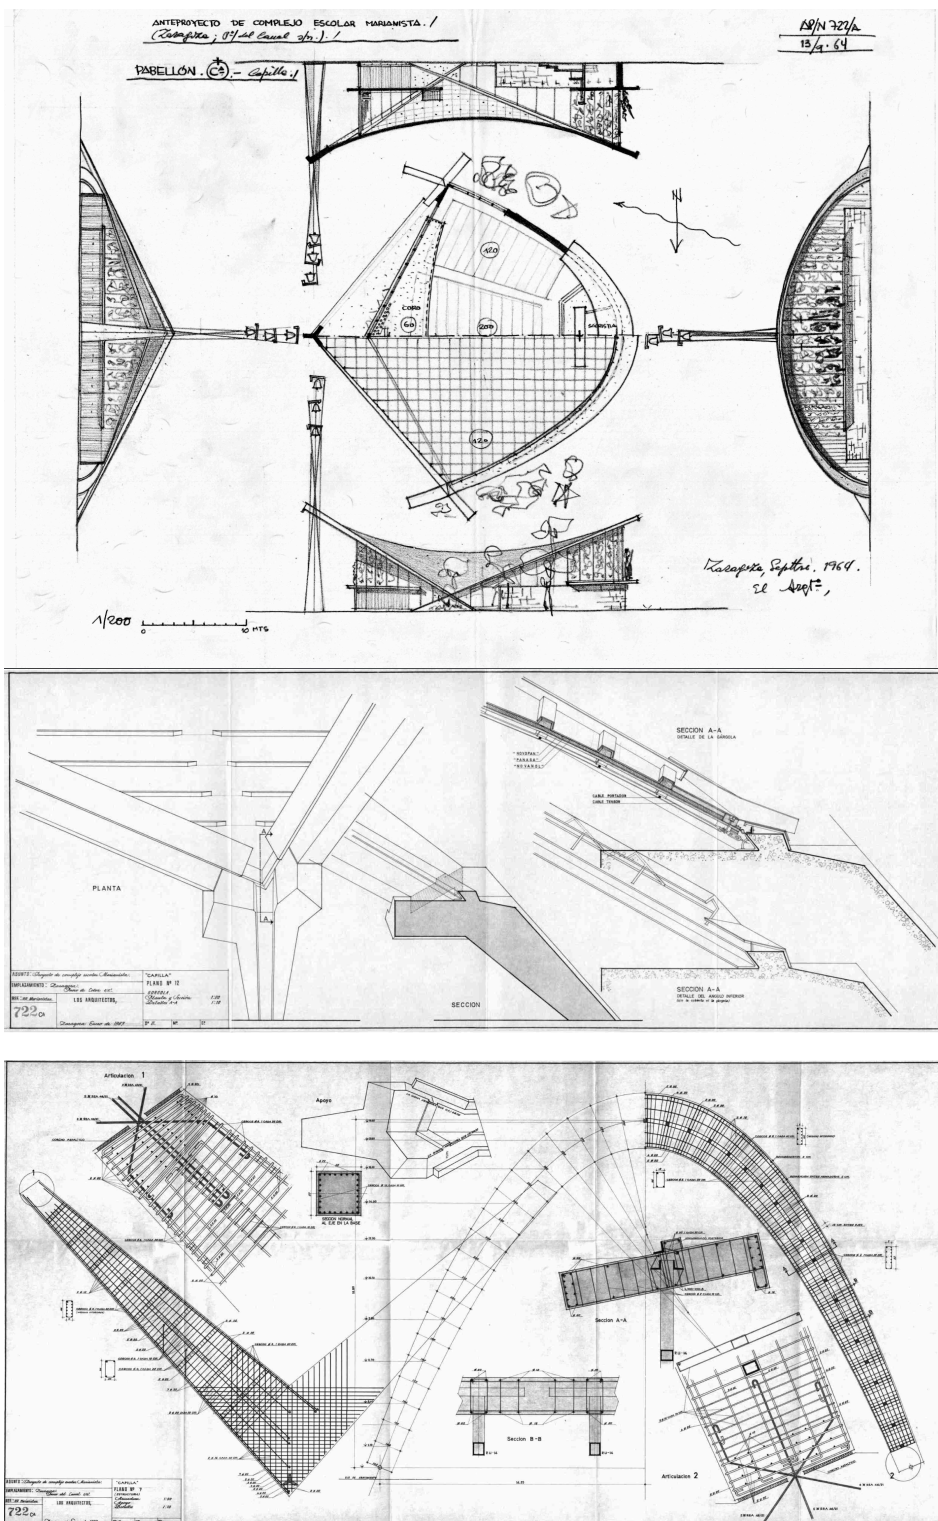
Planta, alzados y sección, Capilla de los Marianistas, Zaragoza
